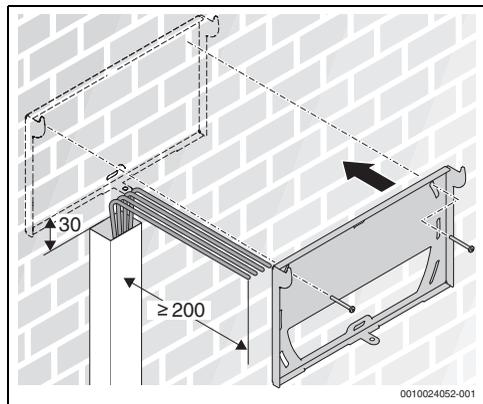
Installare il supporto a parete (dimensioni in mm)
